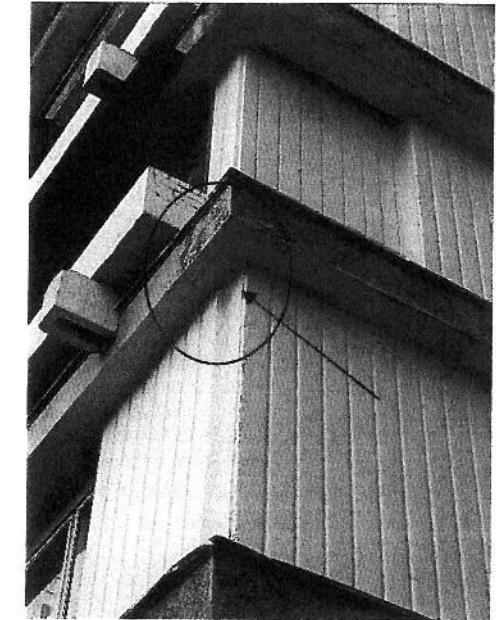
Стеновые блоки карнизов – не произведена очистка от окрасочного слоя с гранитной крошкой. Фасад – места замокания и отслоения слоя краски.
